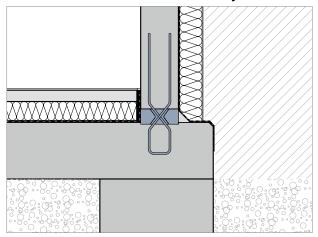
Schöck Sconnex® type W mur extérieur sur semelle filante/barrière antigel
